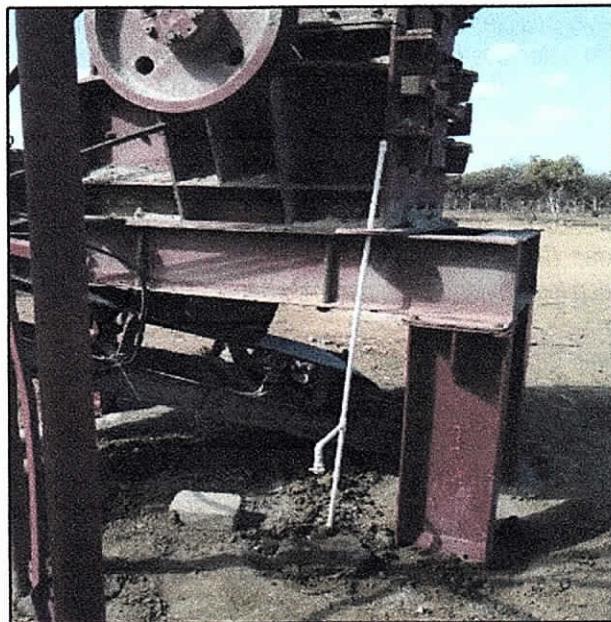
Tubería para sistemas de humectación de la planta trituradora.
